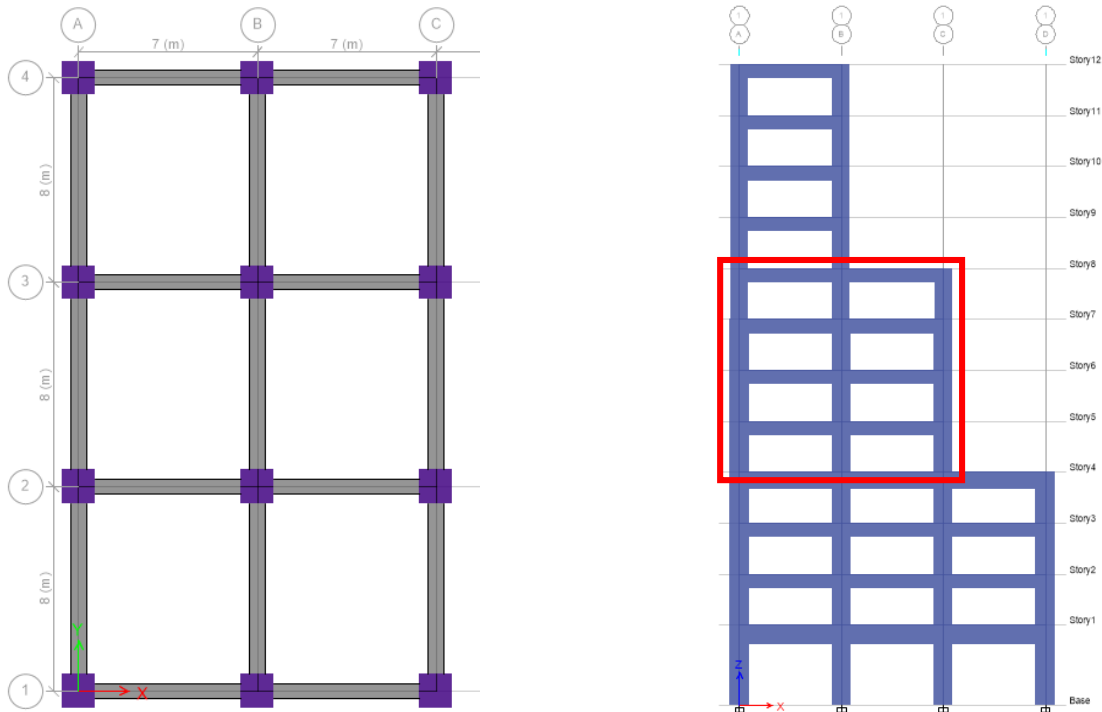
PLANTA DEL NIVEL 5 AL NIVEL 8
